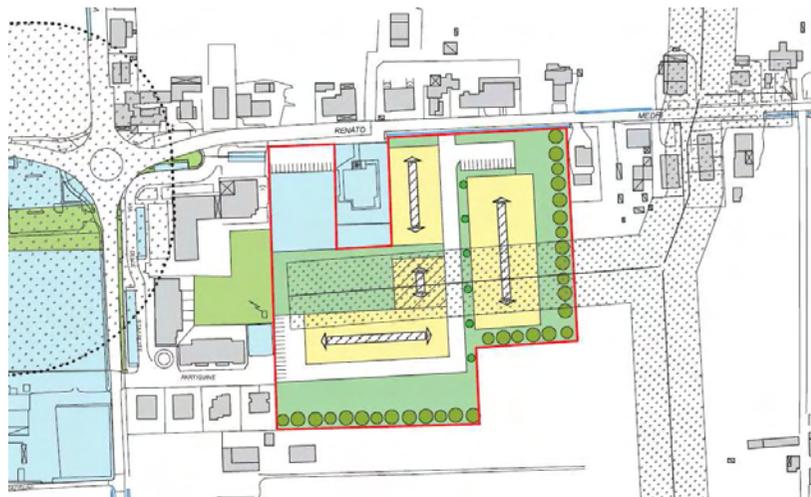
Stralcio vigente Scheda Area di Trasformazione 10/10 AT1-5
